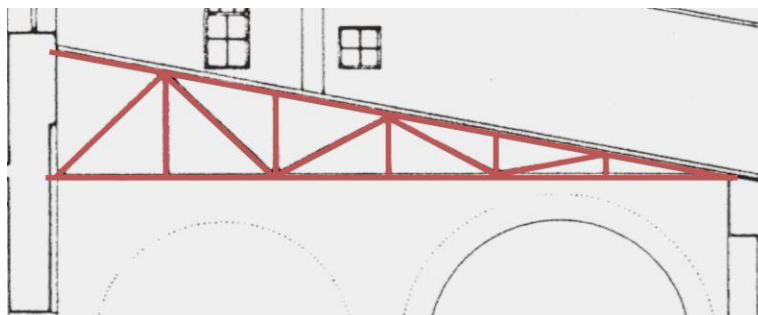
Vista lateral derecha de la estructura central de vigas del almacén norte.
